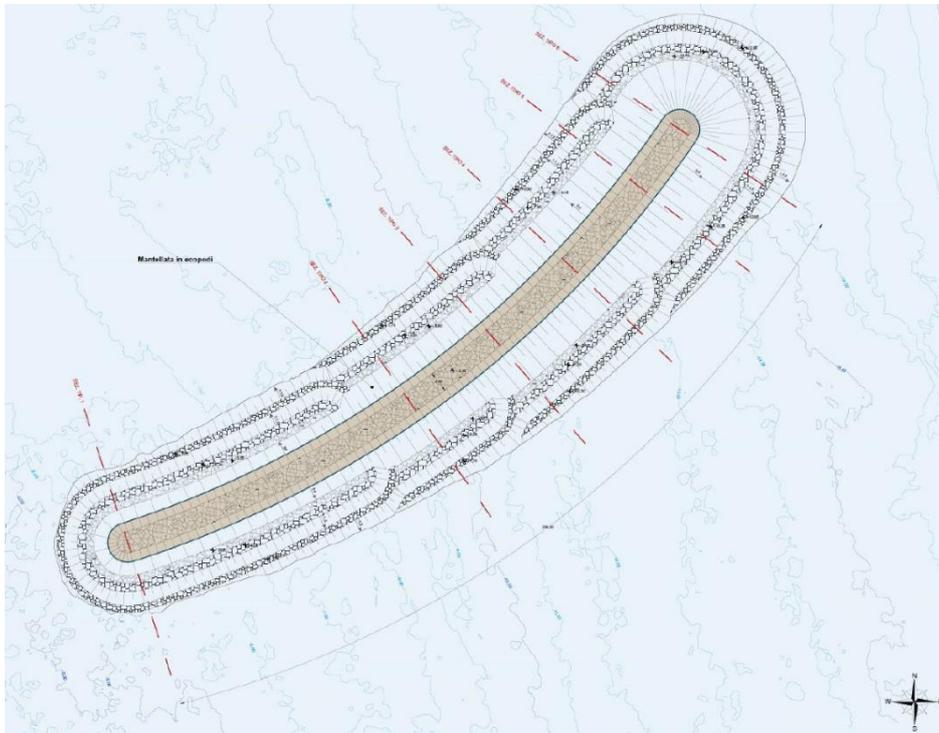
Stralcio planimetria scogliera di protezione dalle onde del II quadrante
